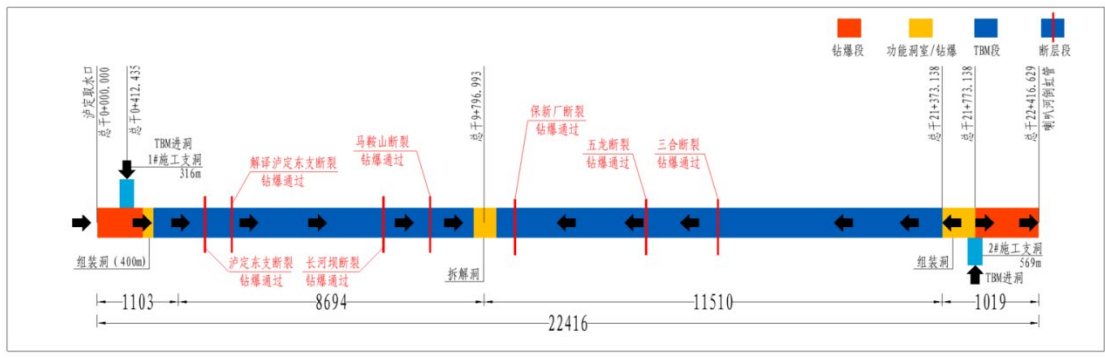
二郎山隧洞施工方案示意图 (TBM+ 爆破)
